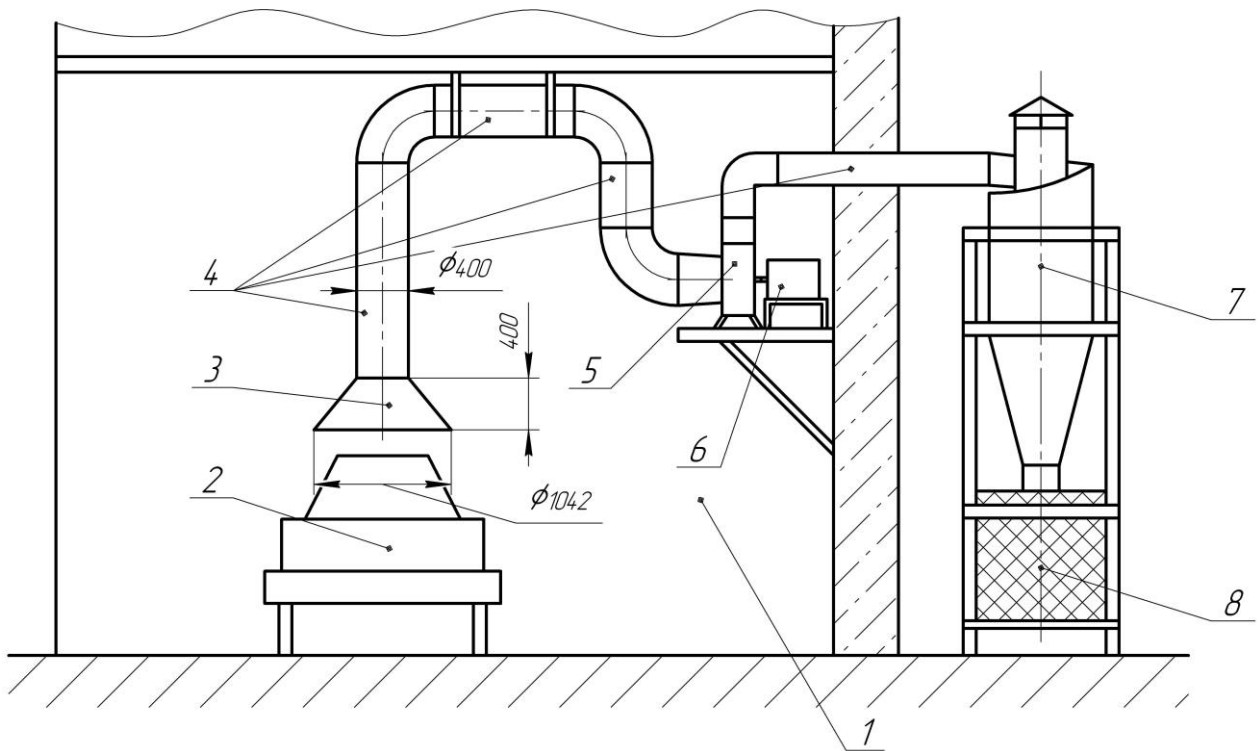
Расчетная схема вентиляции: 1 – производственное помещение, 2 – дробилка, 3 – вытяжное устройство, 4 – основной воздуховод, 5 – вентилятор, 6 – электродвигатель, 7 – циклон, 8 – приемный бункер
